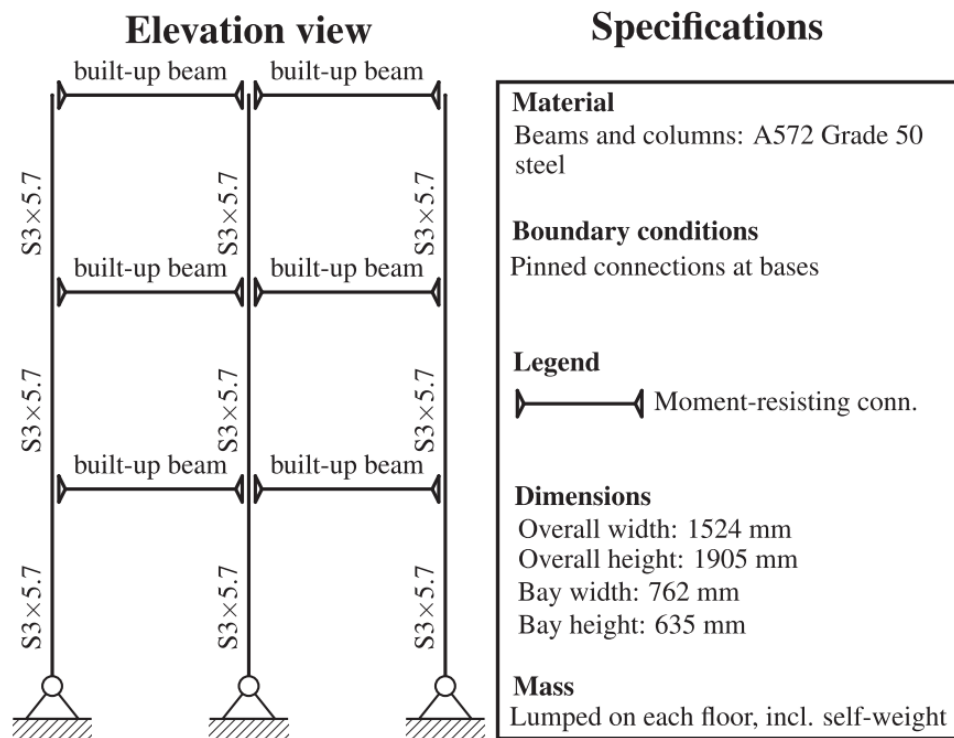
Modelo de la estructura de ingeniería (Silva y cols., 2020)
